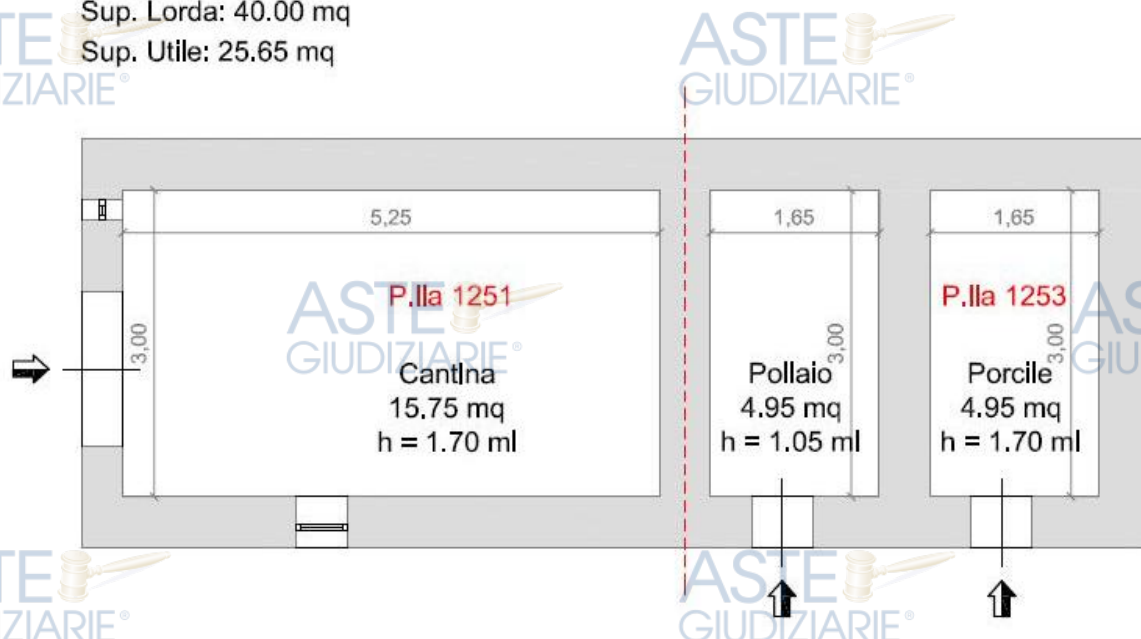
Planimetria Stato di Fatto Piano Seminterrato Foglio 31, p.la 1251-1253.
